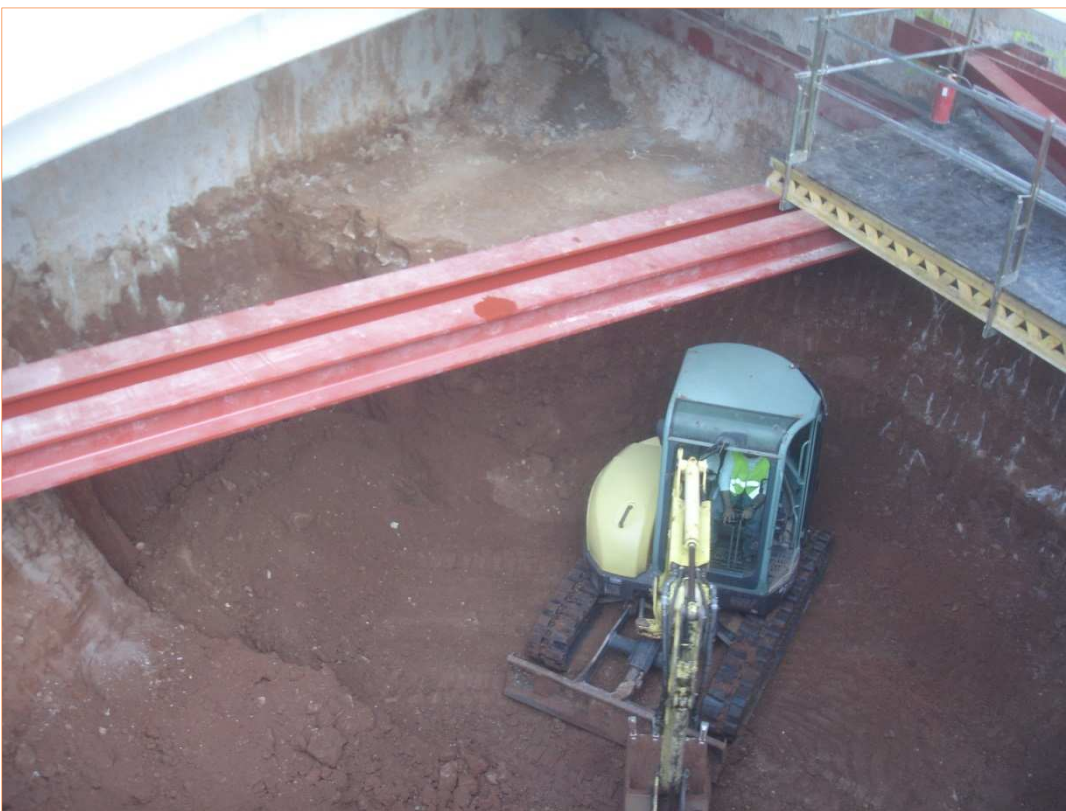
Vista dels darrers treballs de rebaix de la primera fase de la sortida d'emergència.
